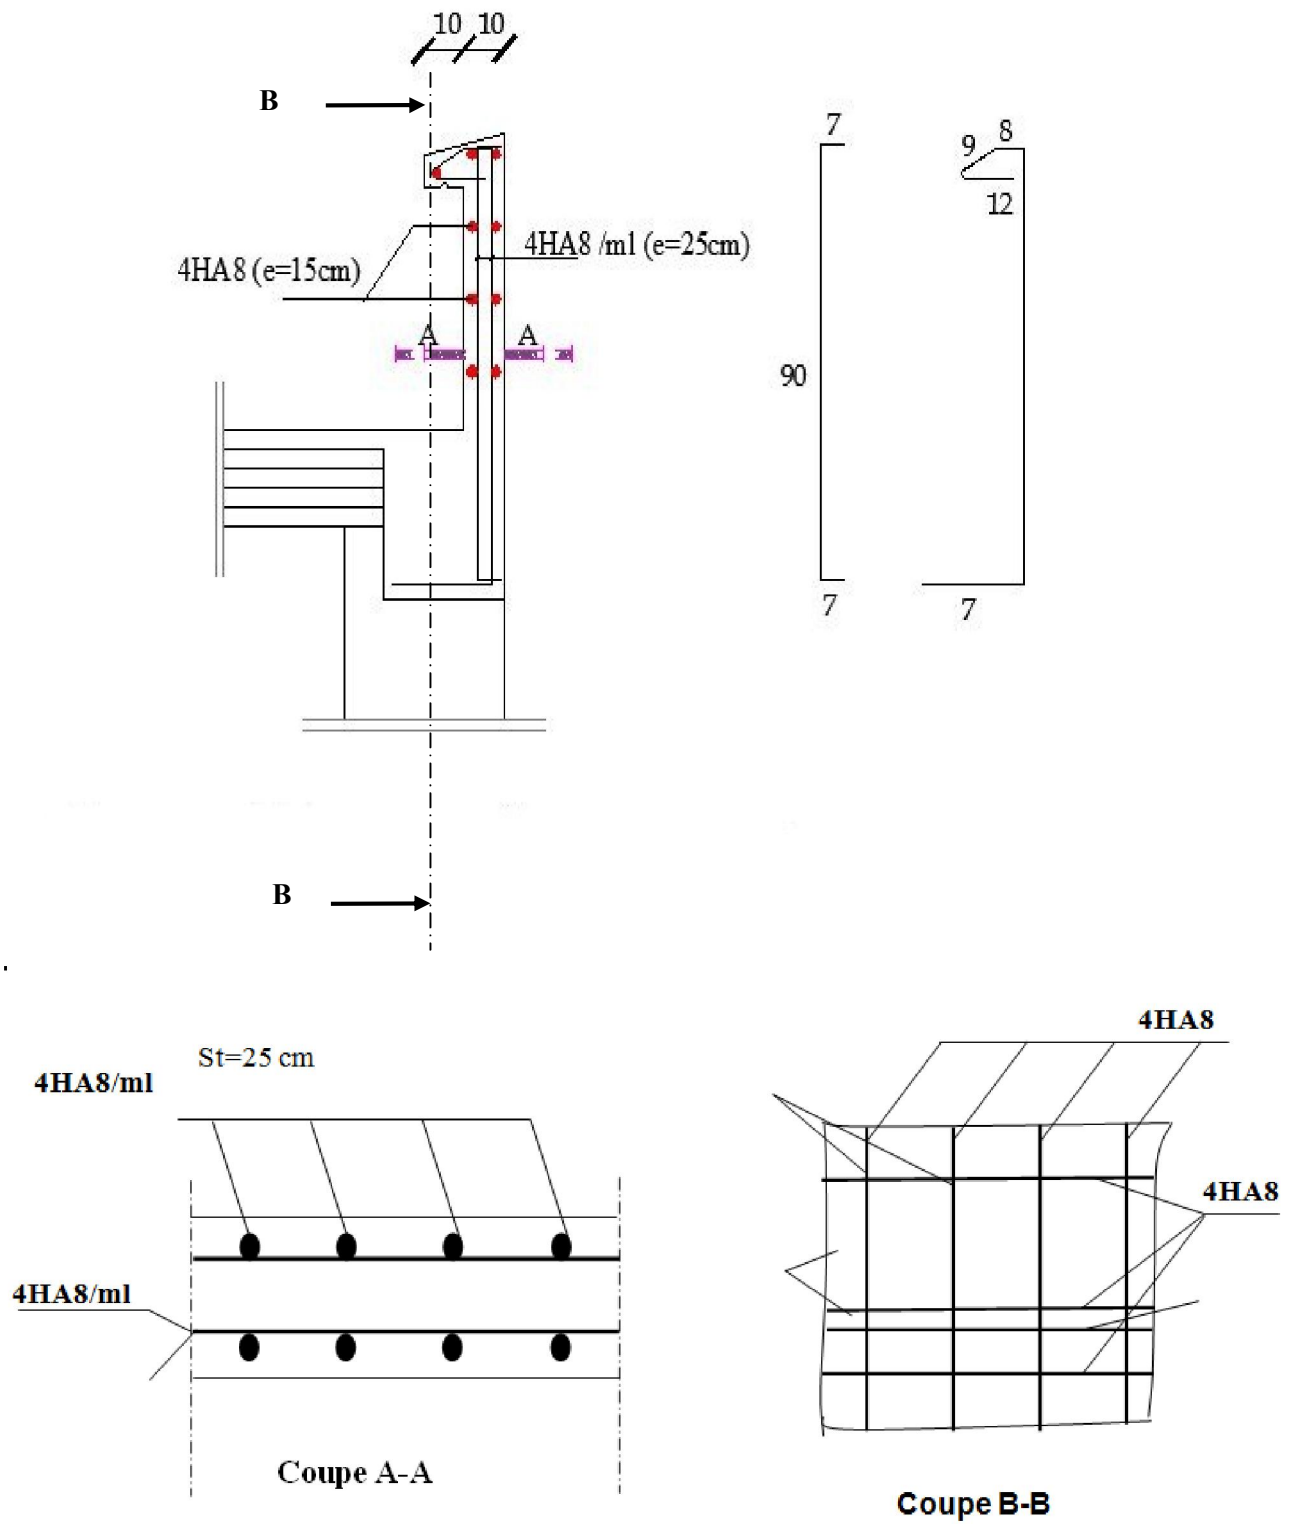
Plan de Ferrailage de l'acrotère.
